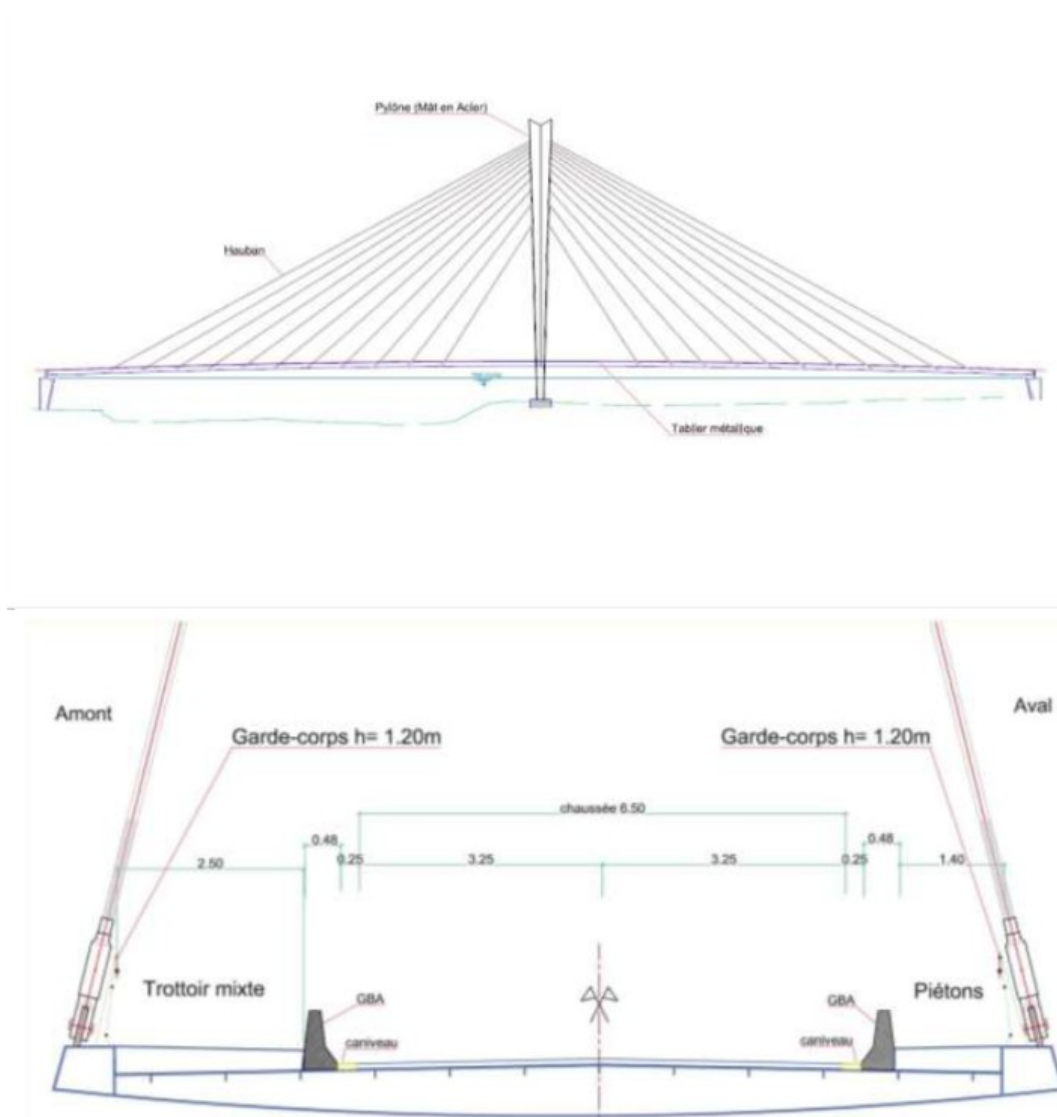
Élévation et profil en travers de l'ouvrage projeté. Source : présentation.
